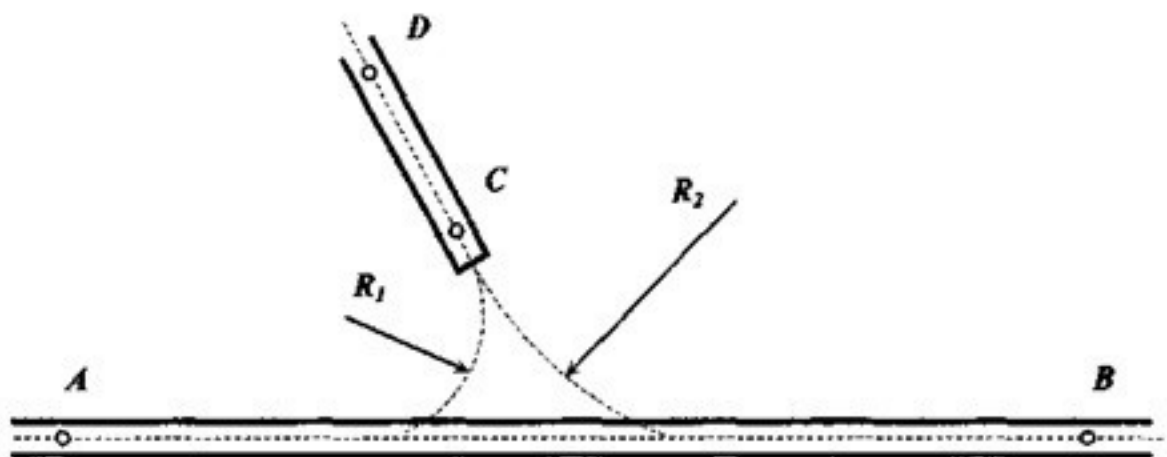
Схема сопряжения горных выработок для вариантов 6-10
